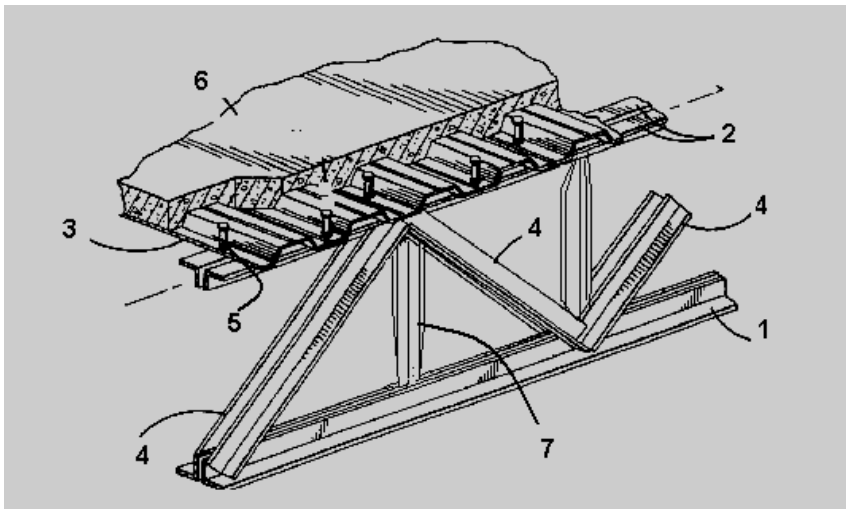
Sistema de pisos com vigas treliçadas (joists) [59]
